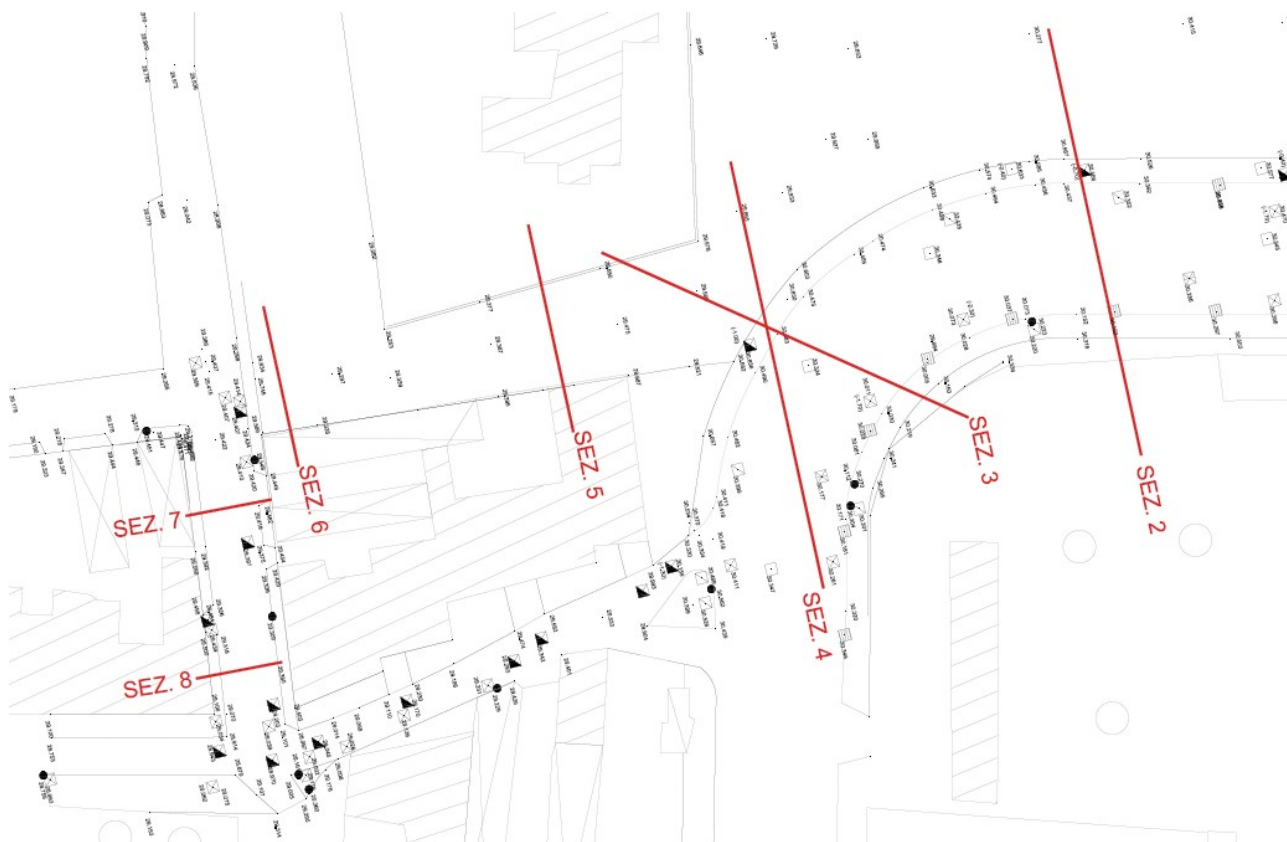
PLANIMETRIA DI RILIEVO DELLO STATO ATTUALE
